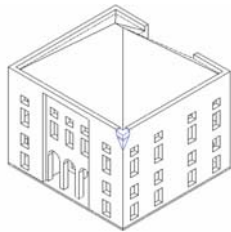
Schadenstyp P17: Auskippen der horizontalen elementen im Dachgeschoss und Giebelbereich
